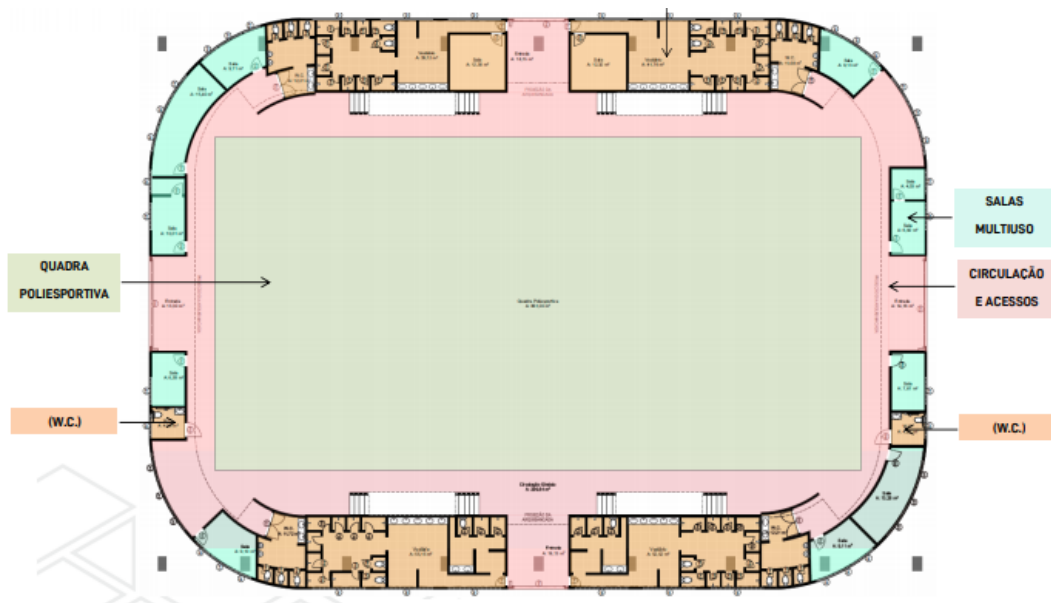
Planta com setorização do pavimento térreo. Sem escala
